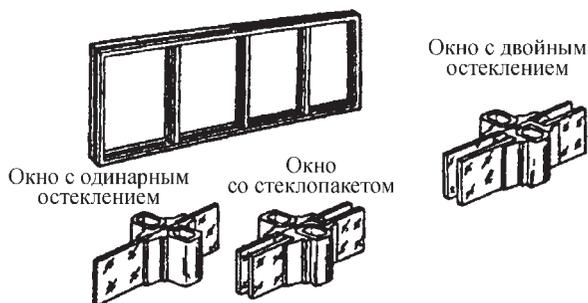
Конструкция окна из спаренных прямоугольных труб без фрагуг
